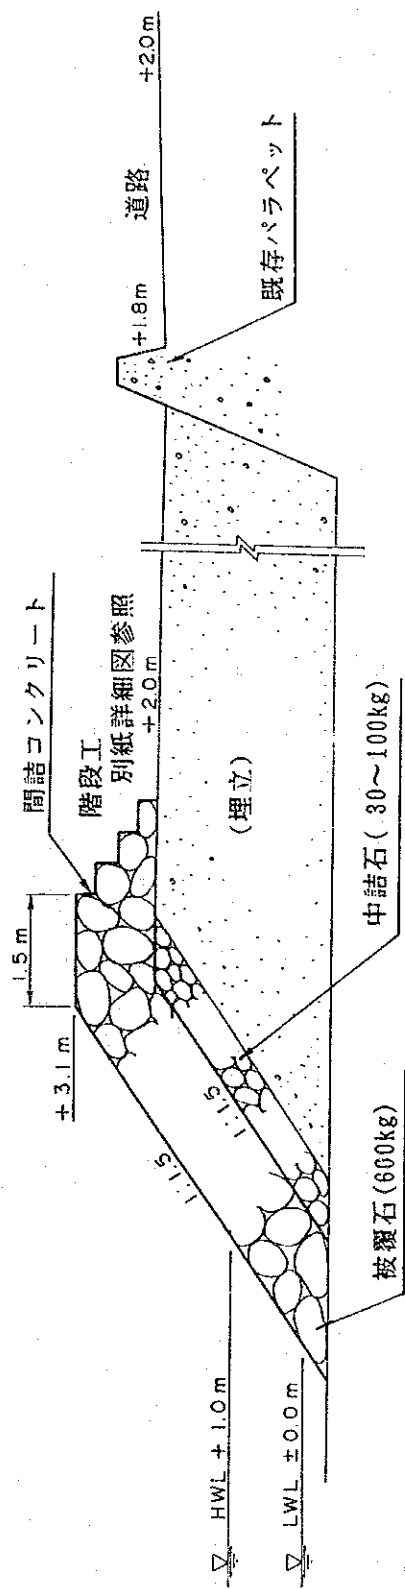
海岸保全施設、標準断面図 (E - F 区間)
